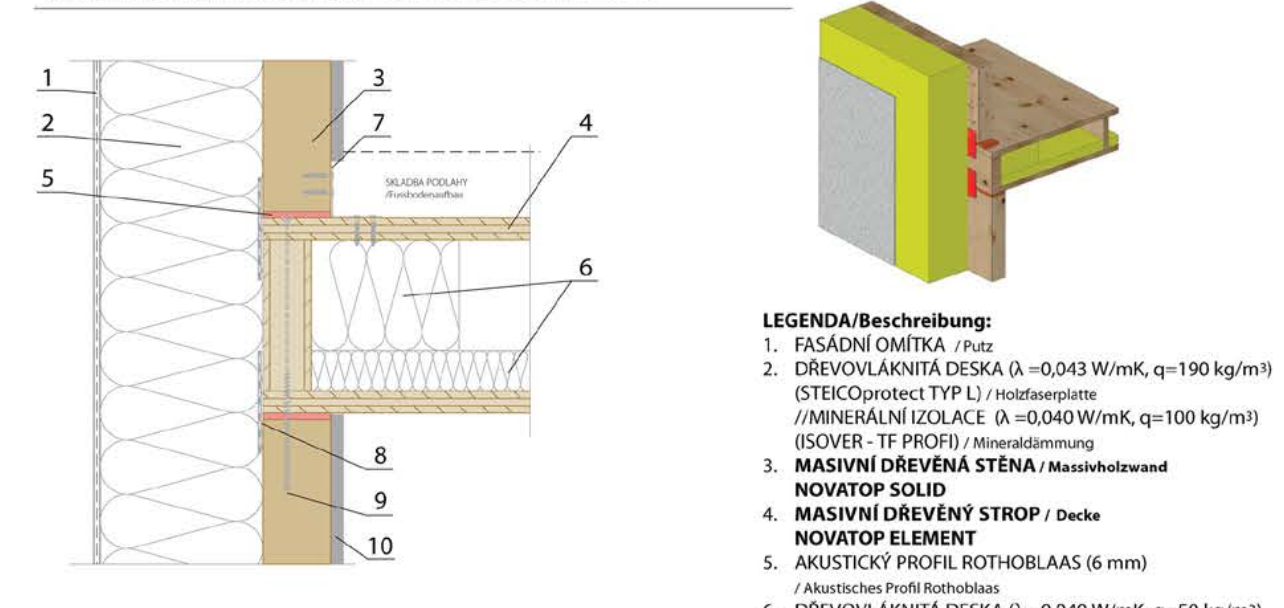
DETAILY ROHOVÝCH A PODÉLNÝCH SPOJŮ
